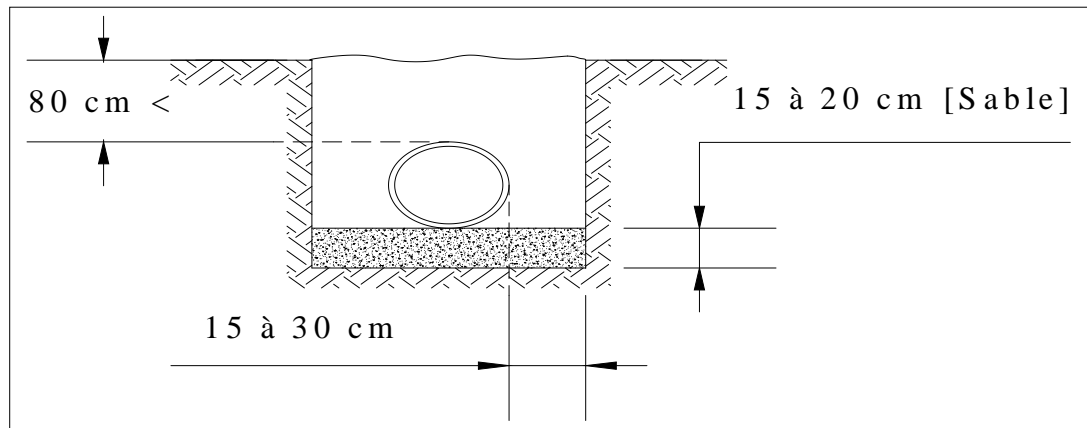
Pose de conduite dans un terrain ordinaire.
